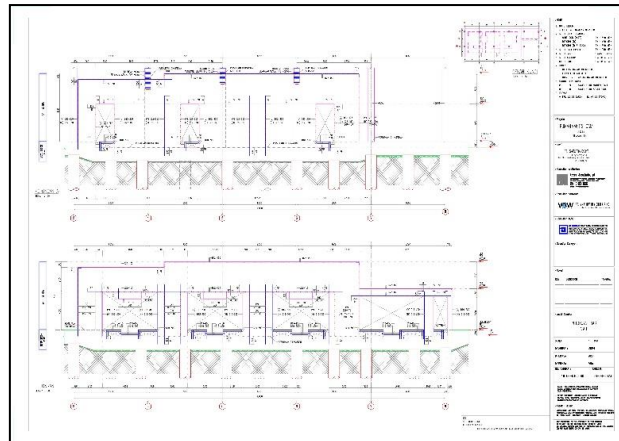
Denah Rencana Proyek New Siloam Hospital
